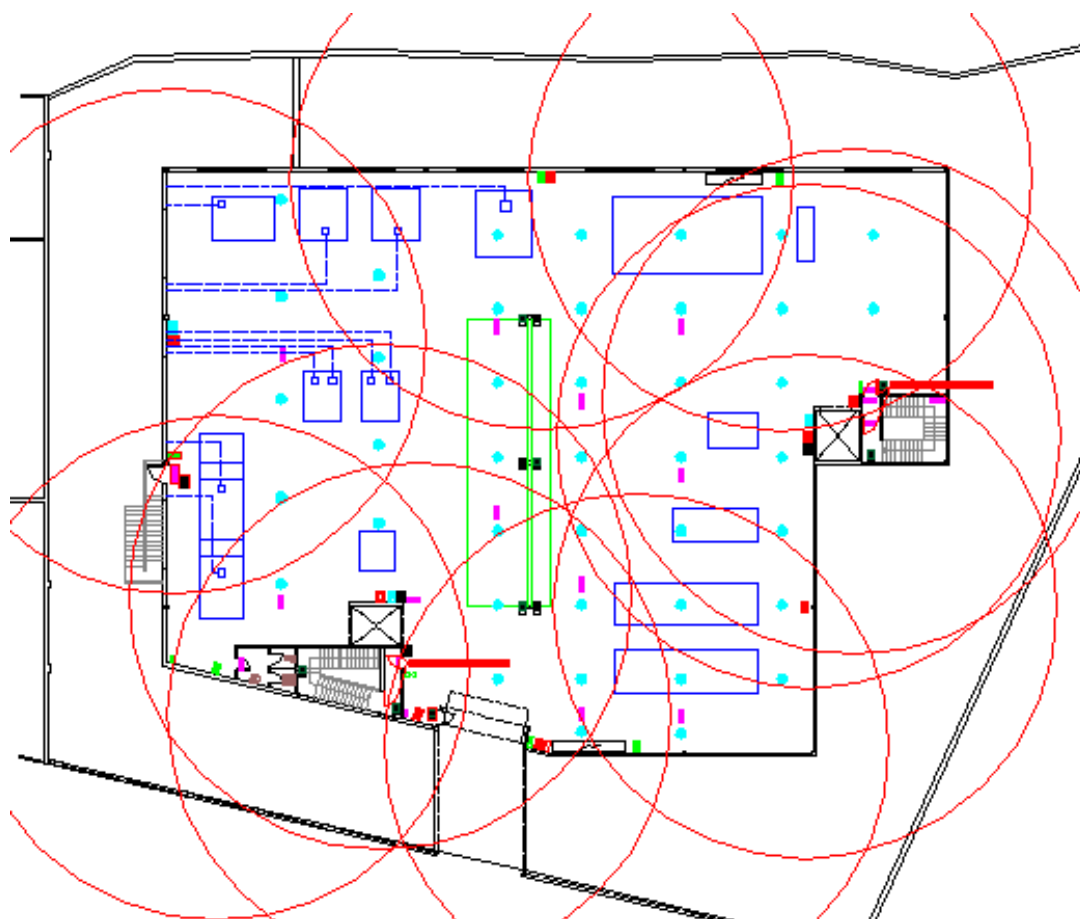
Superficie cubierta por los extintores en la planta primera del edificio Almacén
